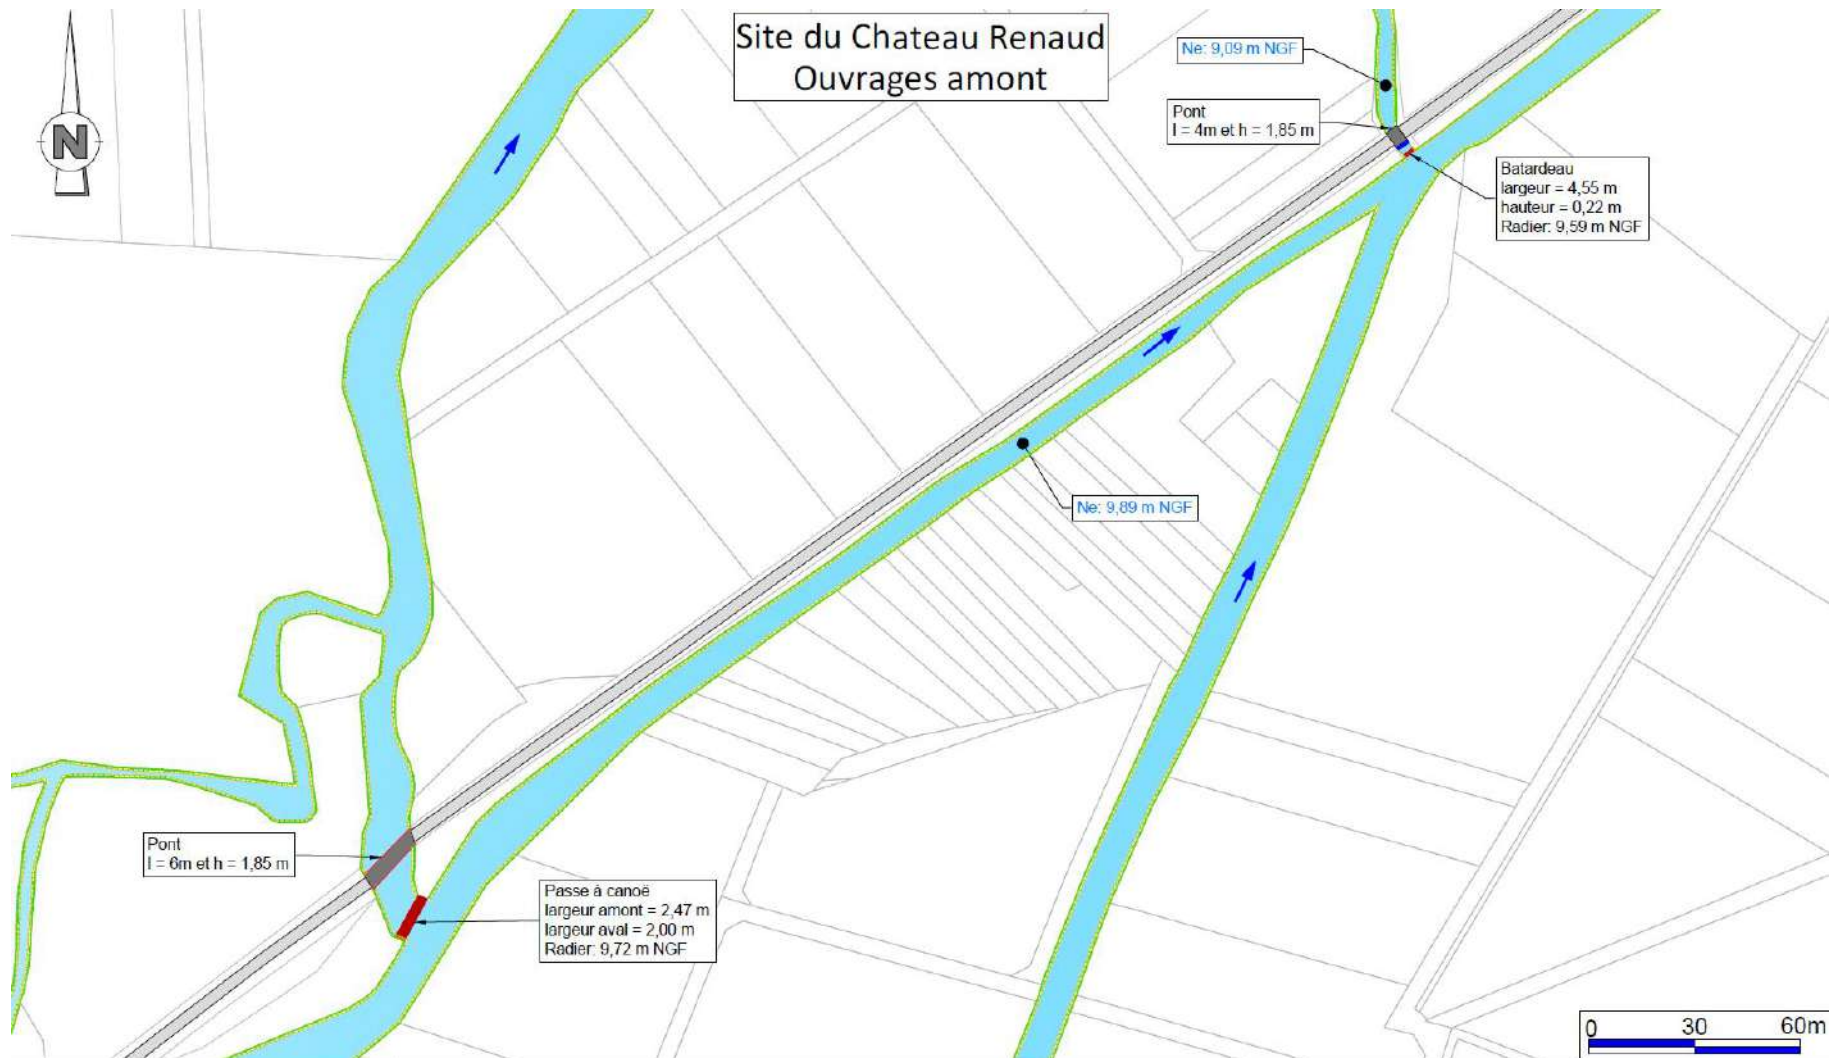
Vue en plan des ouvrages de décharge en amont du site de Château Renaudt
